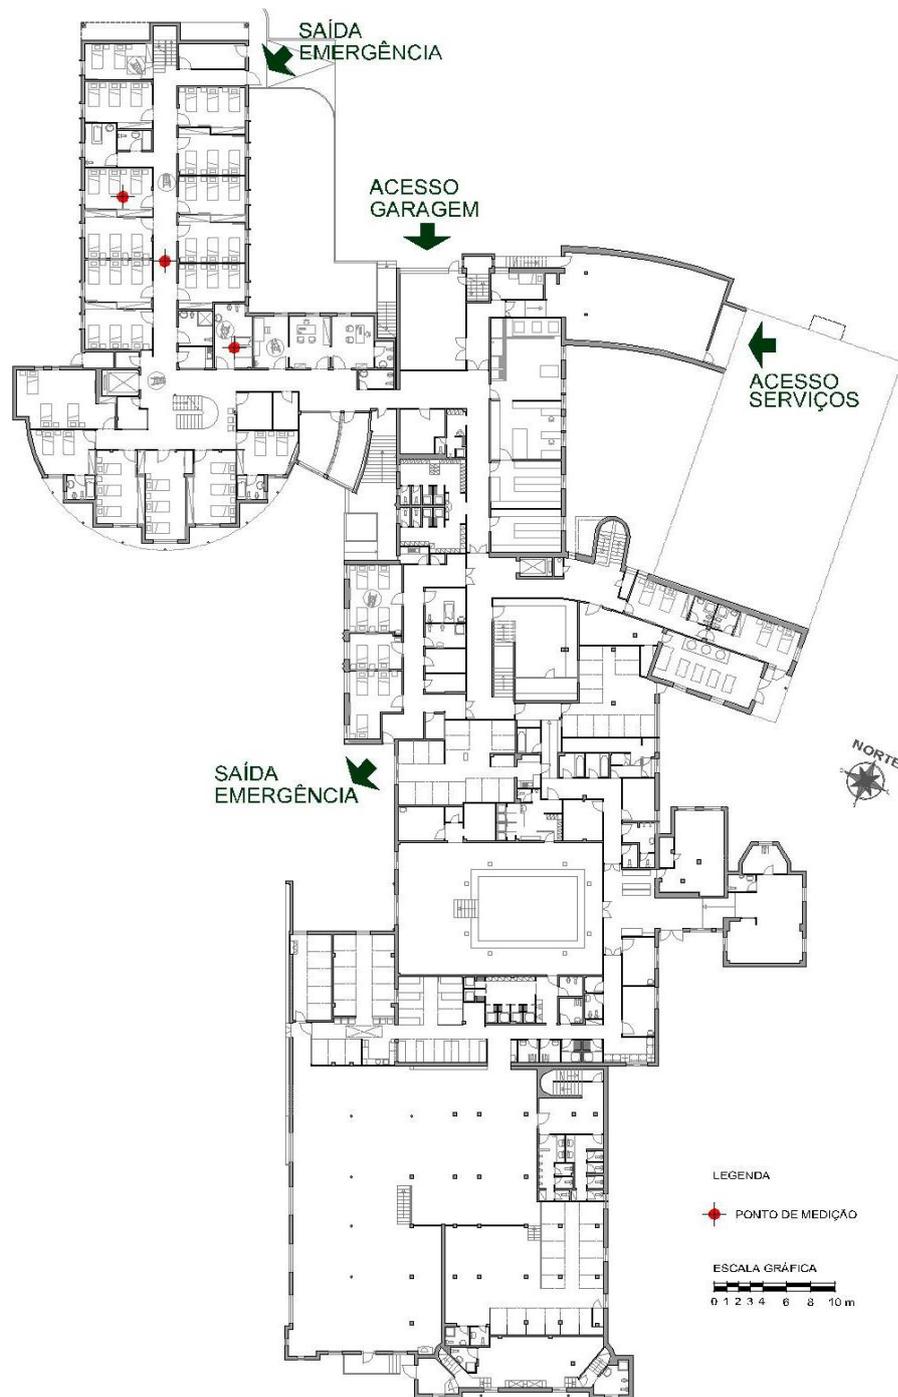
ILPI 1 - Pontos de medição de iluminância e ruído - 1º pavimento.
